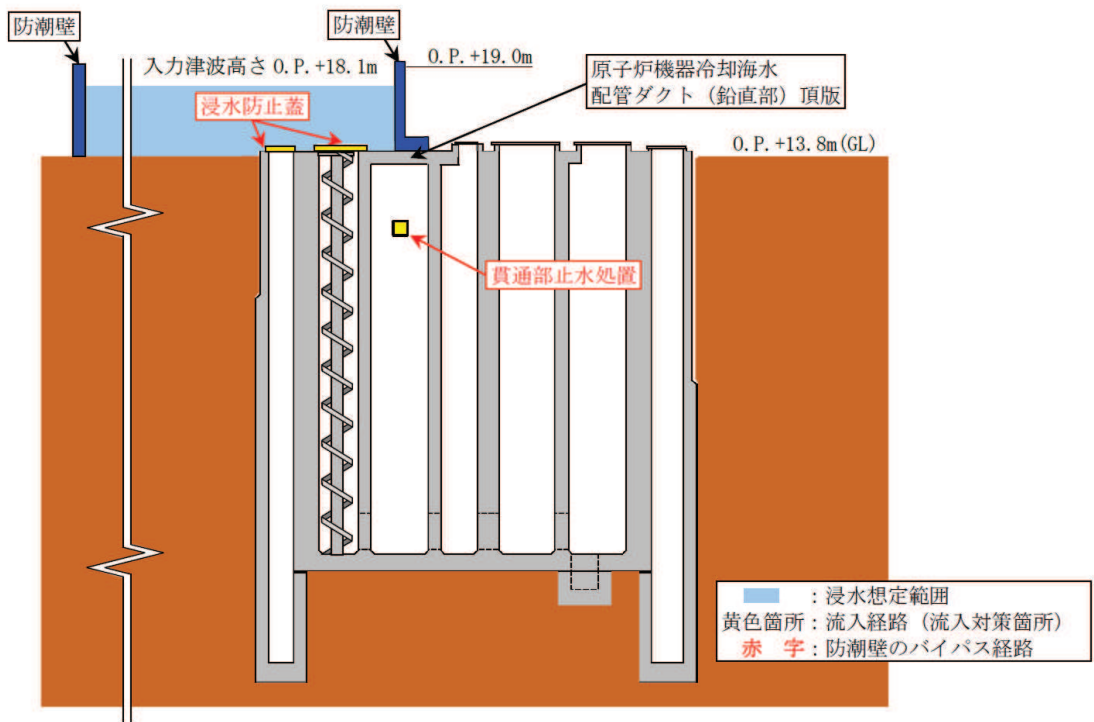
第 2 号機 海水ポンプ室 流入対策配置図 (B-B 断面図)
